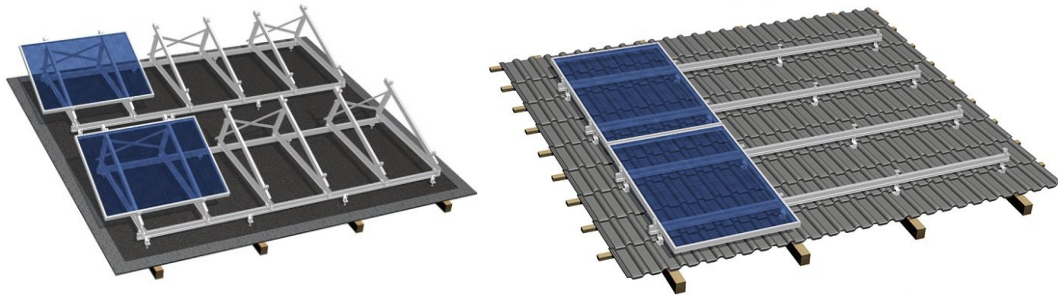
Estructuras de montaje a techo inclinada (izq.) y paralela (der.).
